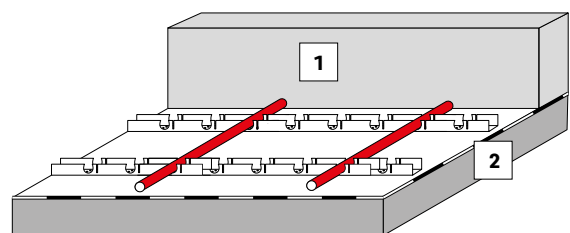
Mit Stahlfasern bewehrte Bodenplatte und Walzbeton; Sonderkonstruktion Heizungsrohre auf den Klemmschienen montiert
